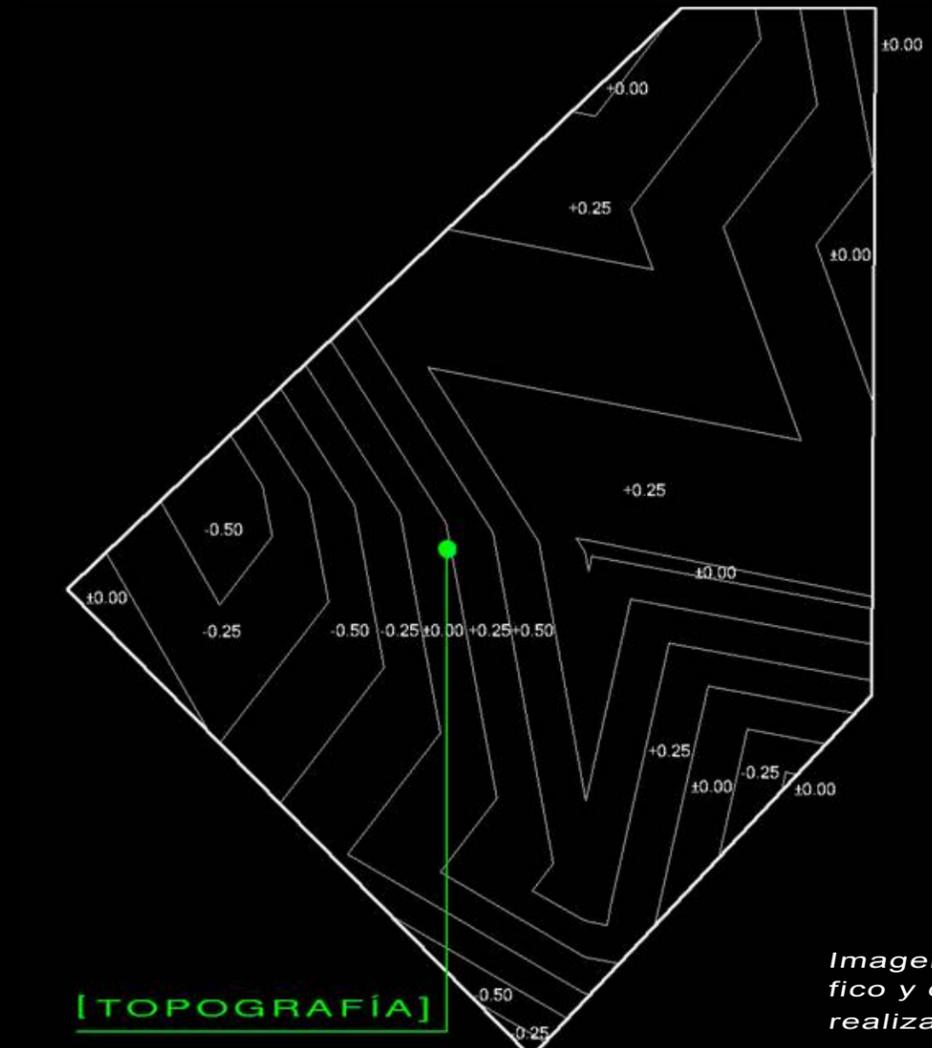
plano corte topográfico y cuadro de construcción realizado por el autor.
